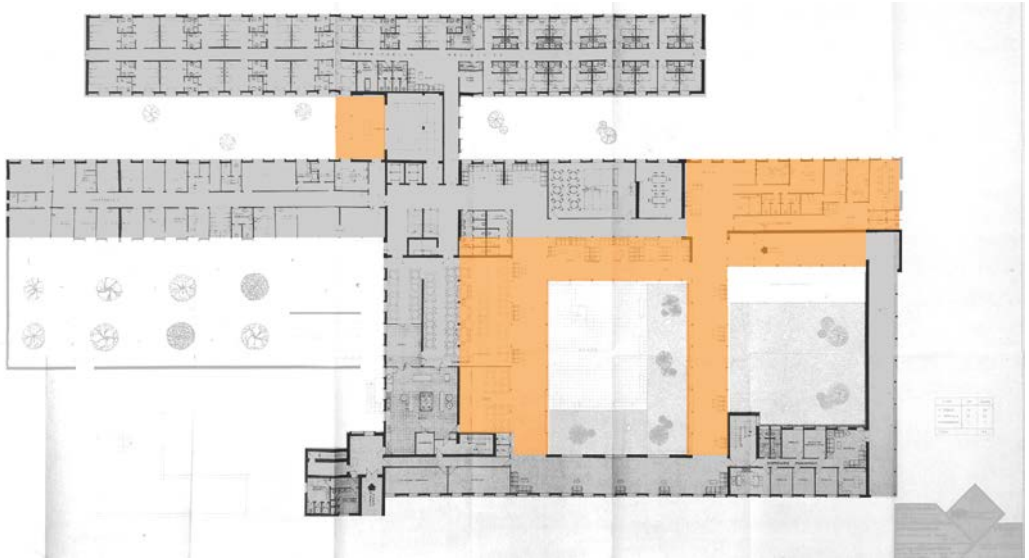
Plano de la planta baja de la nueva residencia, con la edificación existente (en gris) y la ampliada (en naranja). (Imagen coloreada por Isabel Muñoz a partir de una planta del proyecto. (AMC, sig. 935/1).
